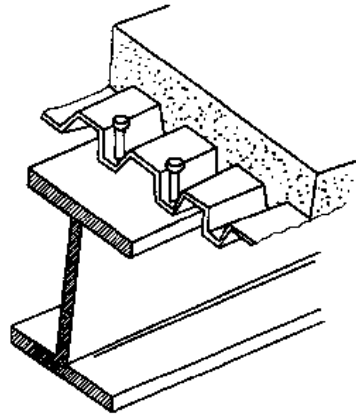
组合板用锚固焊钉与钢梁连接
